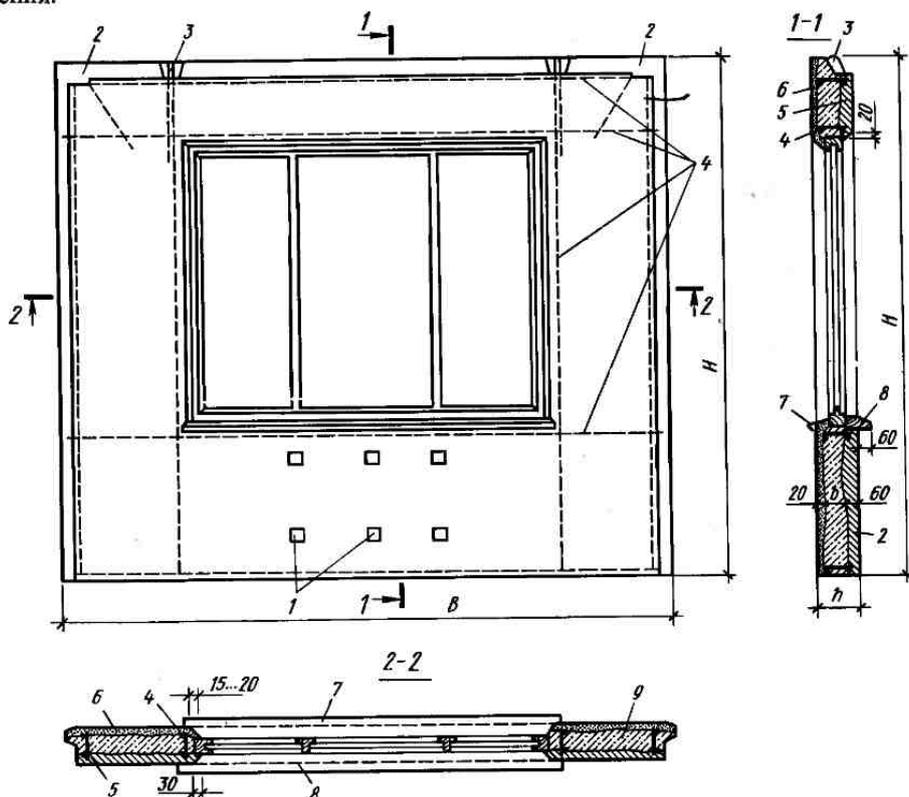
Двухслойная стеновая панель из легкого бетона:
